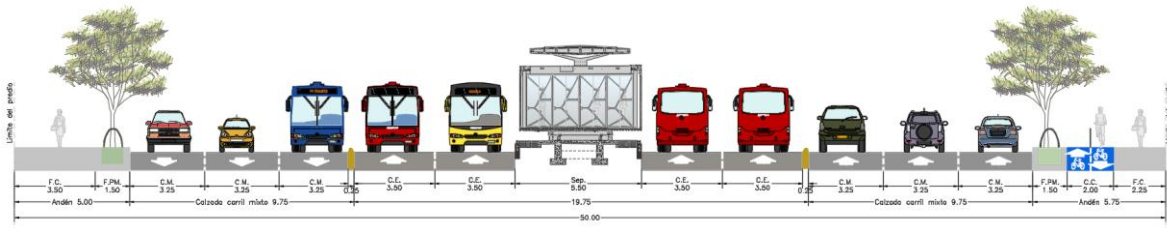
Sección Típica sobre la Autopista Sur entre la Av. 1 de Mayo y la CL 8 Sur.
